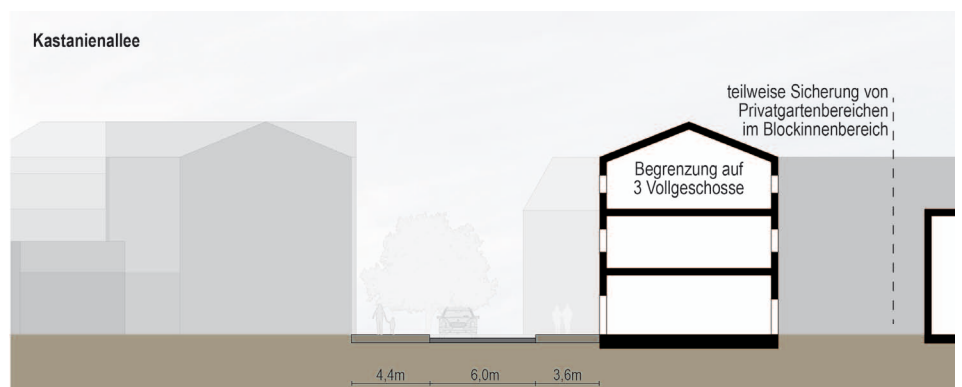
Rahmenplanvertiefung Gründerzeitviertel - Straßenraumprofil der Kastanienallee
